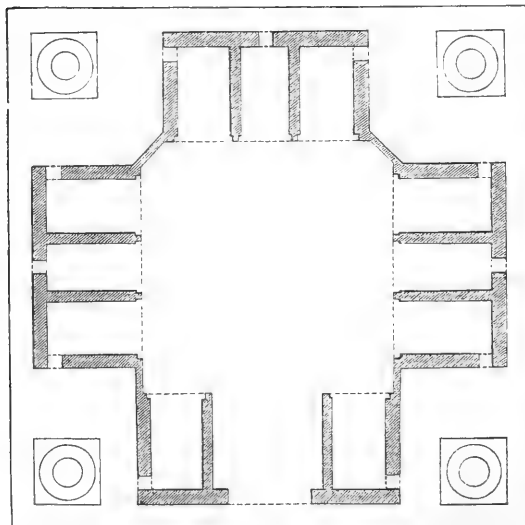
Grundriß zu einem 22fächerigen Pavillon.
